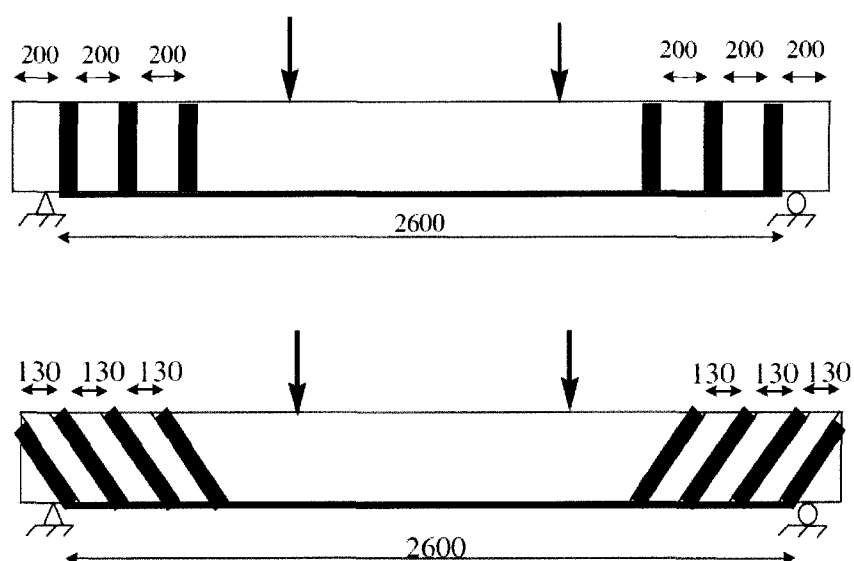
Renforcement d'ancrage par des étriers en composite – Poutre D et E (Buyle-Bodin et David 2004)
